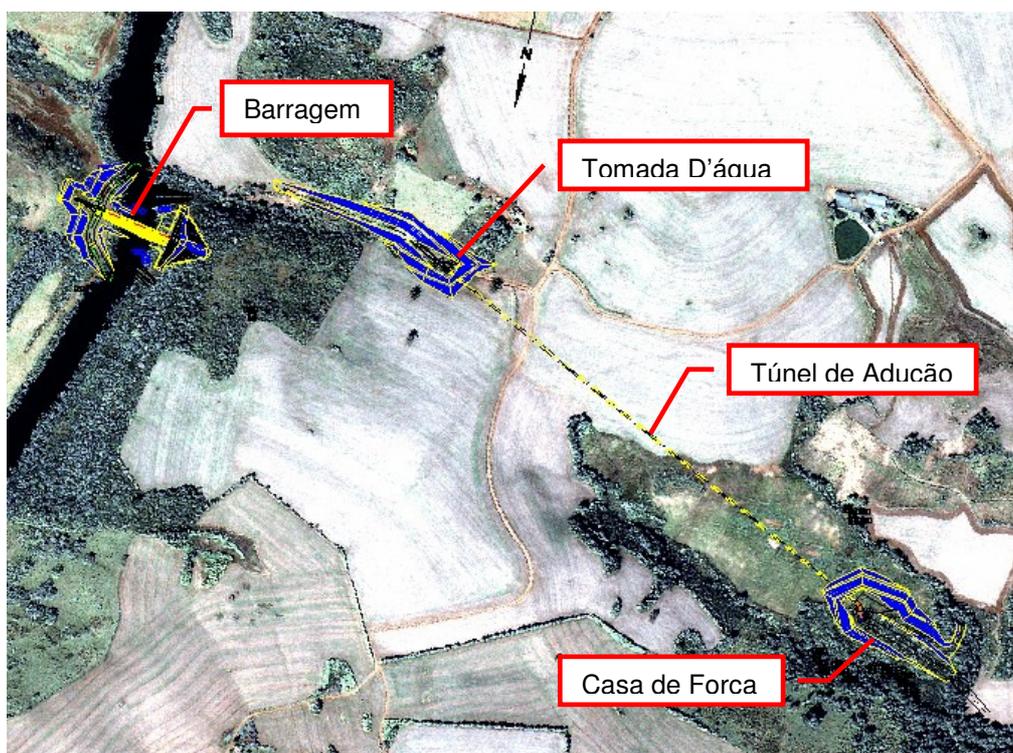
Arranjo Geral da PCH Santa Laura
